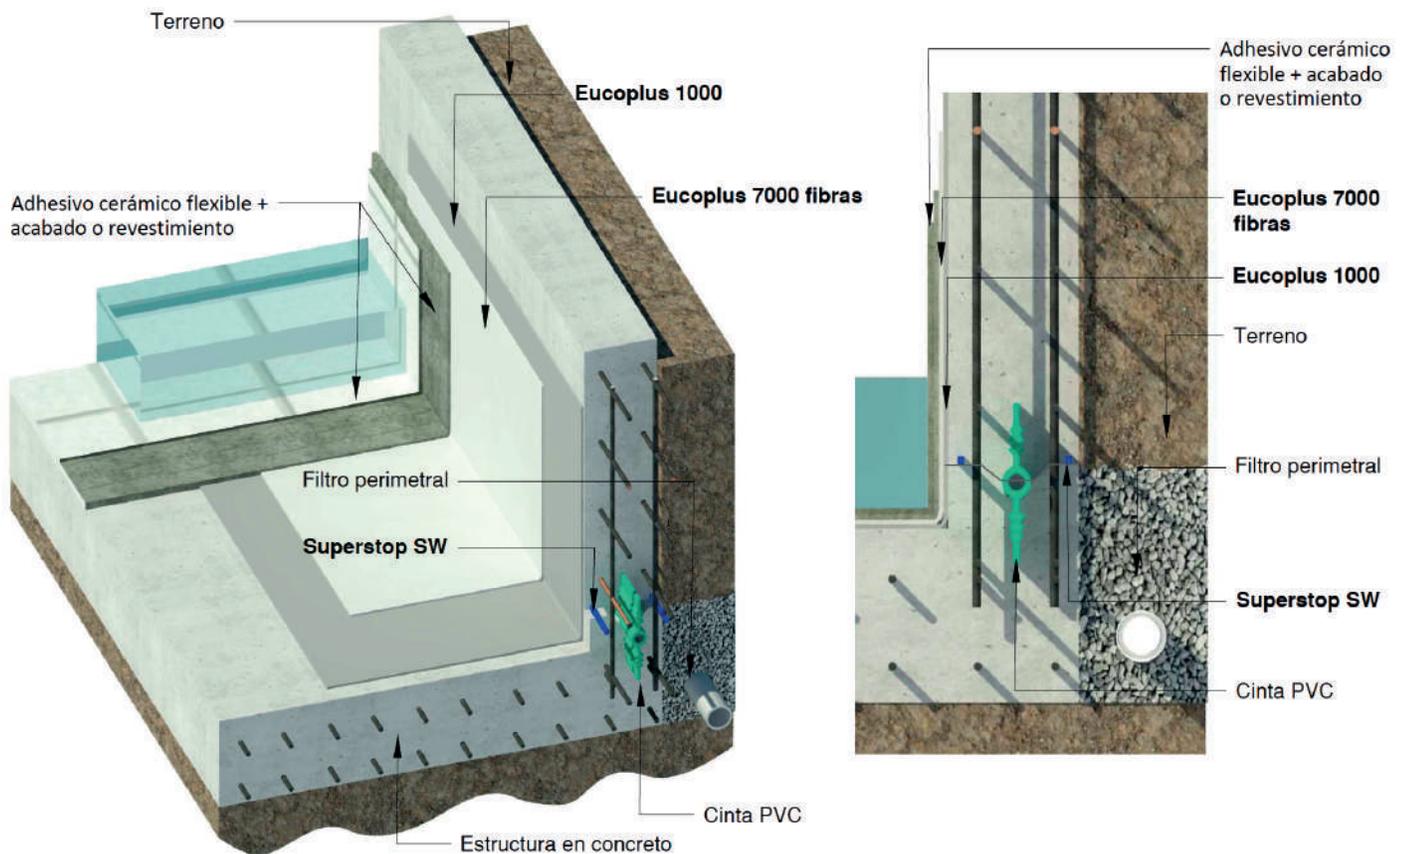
Detalle filtro perimetral y junta en el pie del tanque.
